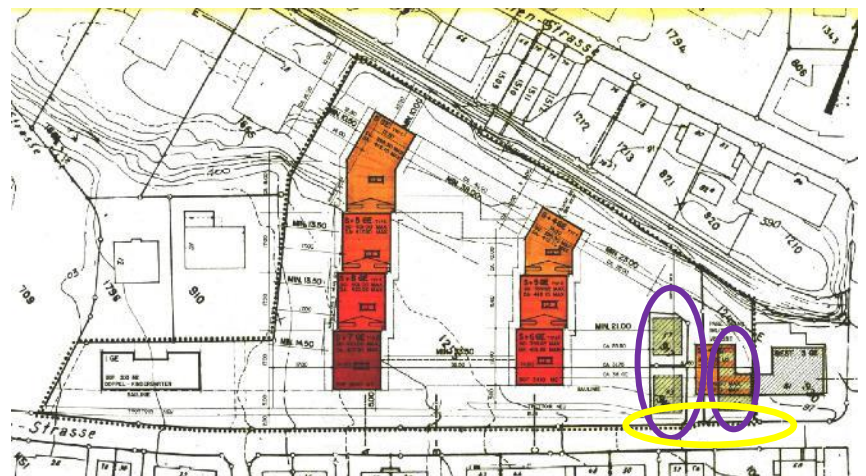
Rechtsgültiger spezieller Teilbebauungsplan Brückenstrasse (RRB Nr. 4260 vom 15. 7. 1975)
